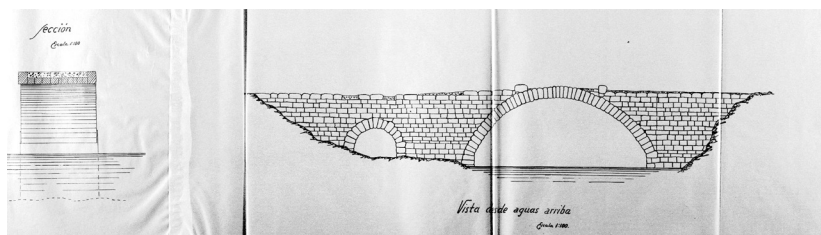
Alzado de Puente Pedriña. Fuente. Informe, 1944.
